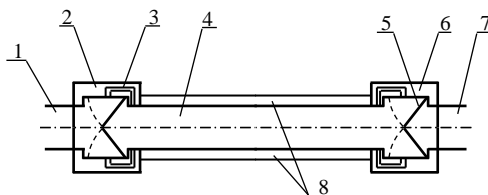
Принципиальная схема плана камеры шлюза:
